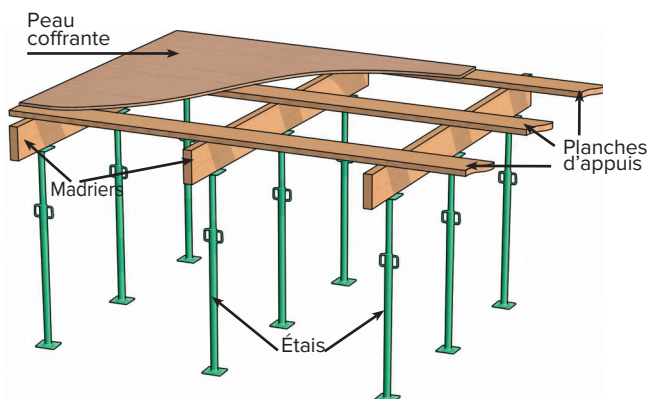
Représentation schématique du coffrage et de l'étaielement d'un plancher à dalle pleine
